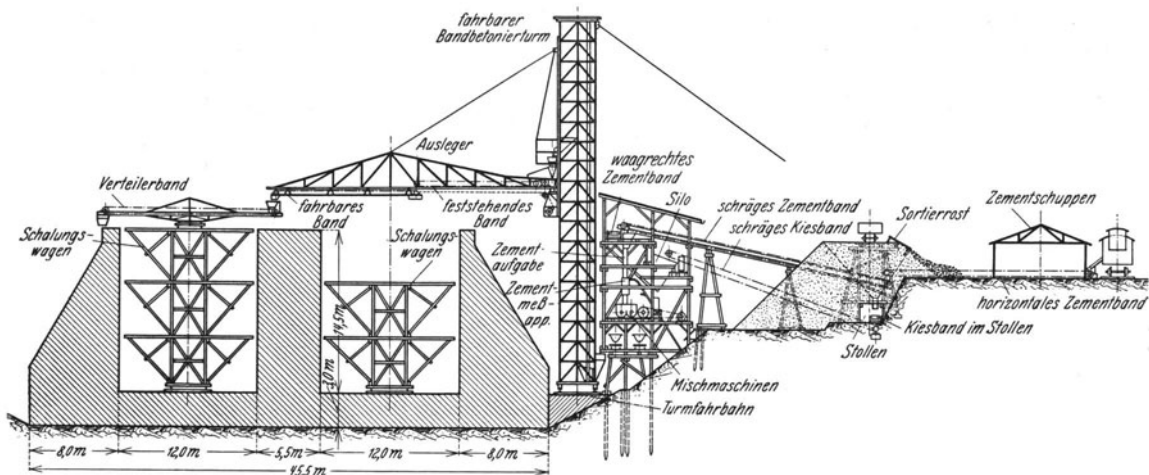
Beton-Bandförderanlage beim Bau der Neckarschleuse Ladenburg.
